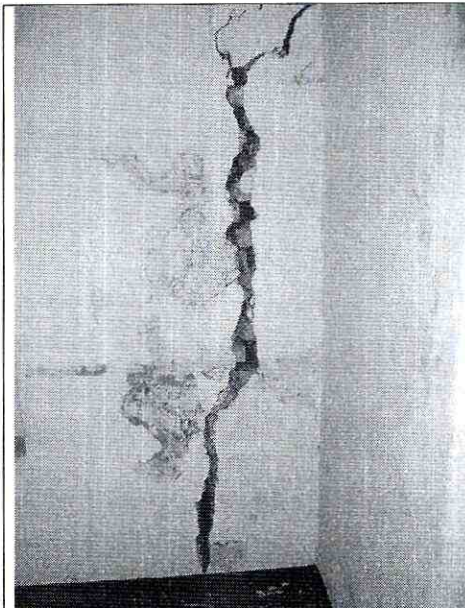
Grieta de tendencia vertical y cerca de 4 cm de abertura en muro del costado norte de la Casa Parroquial.
